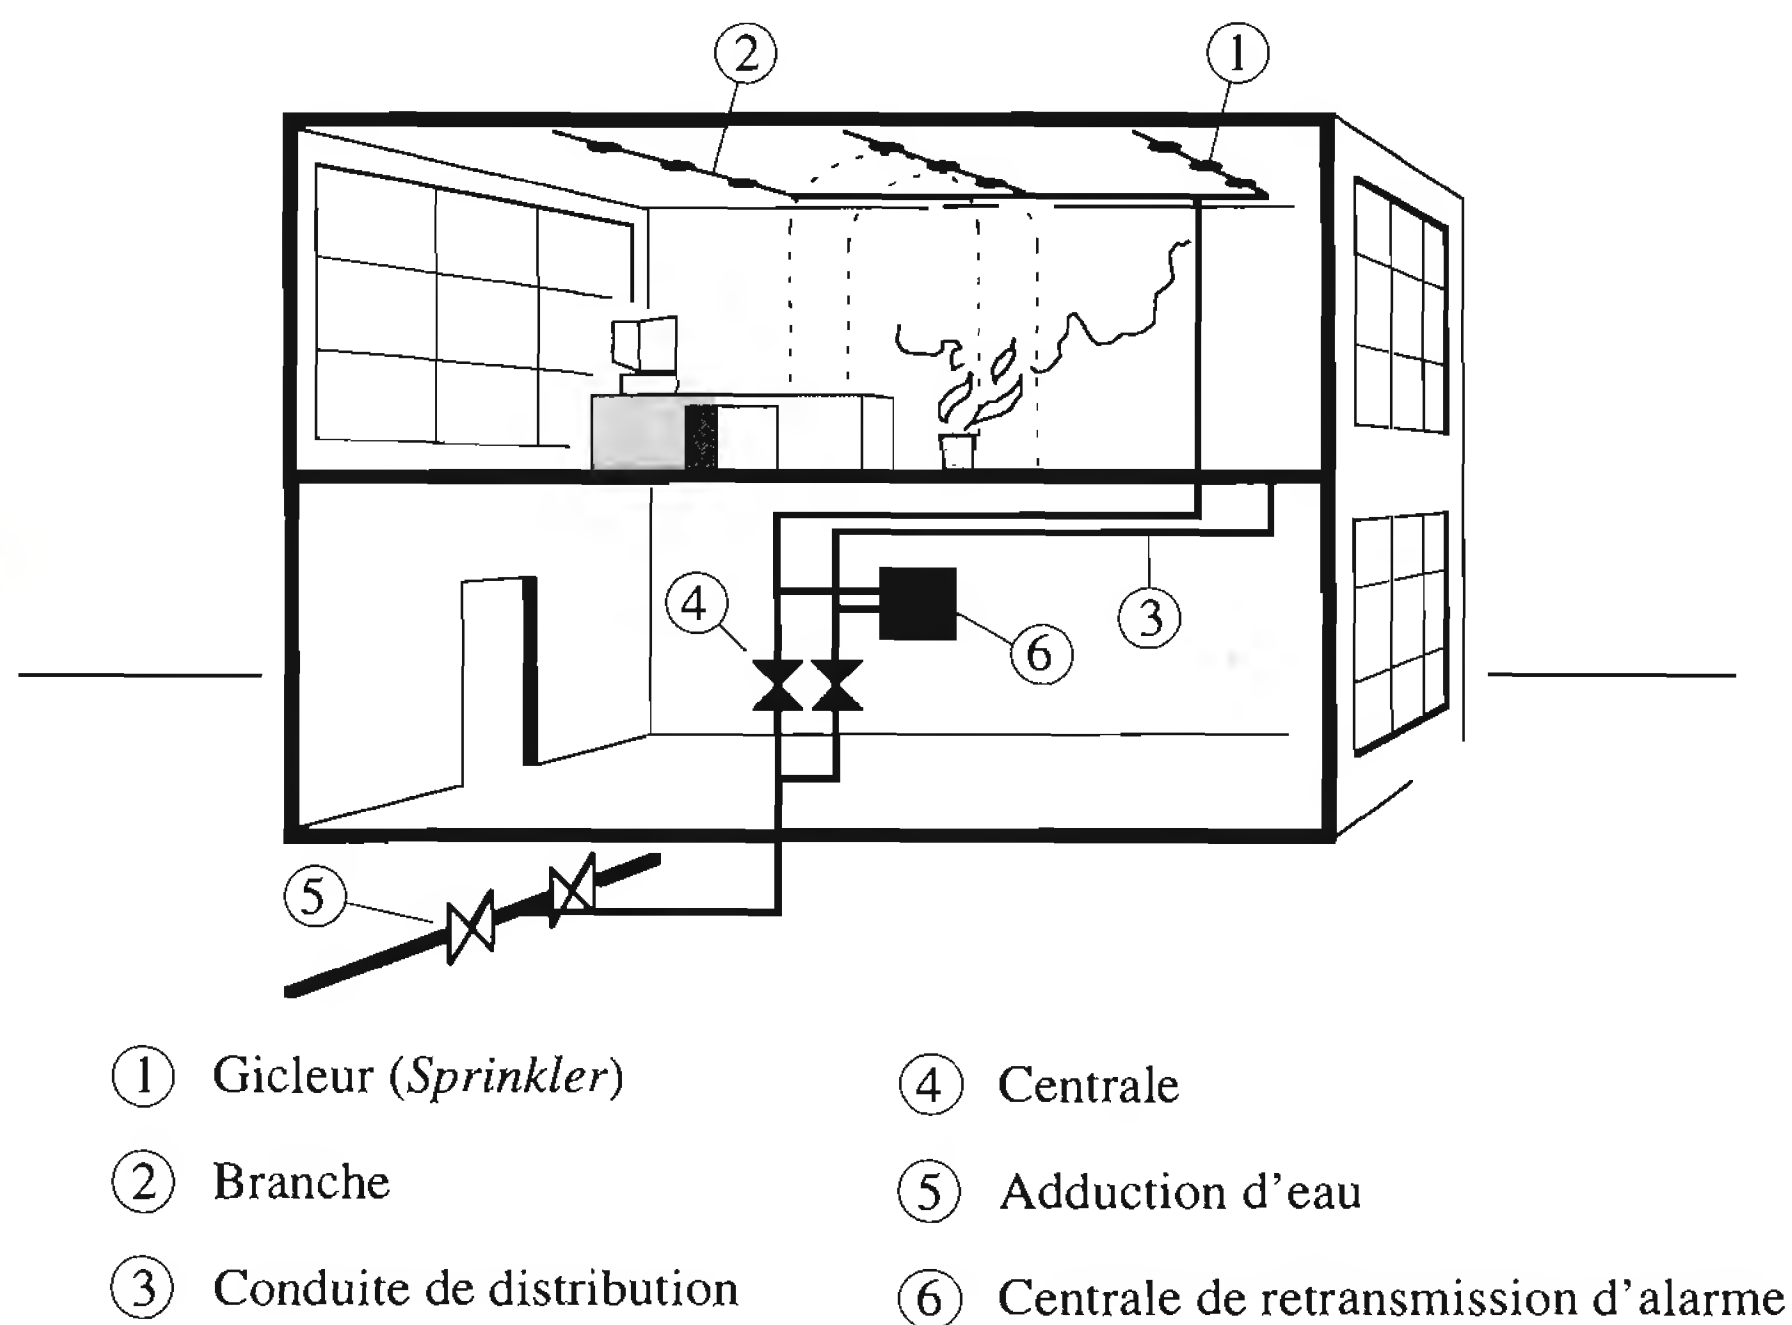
Le concept d'extinction: schéma d'une installation *sprinkler*.
